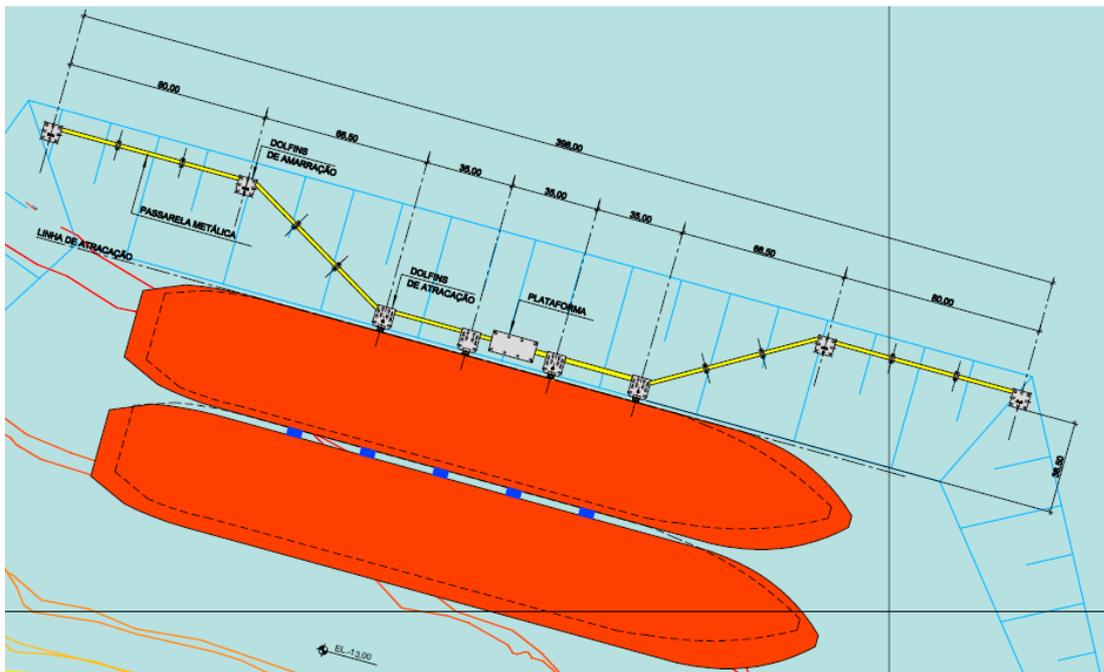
arranjo das estruturas do píer do Terminal GNL. Apresentado em planta no Anexo 7-1.
